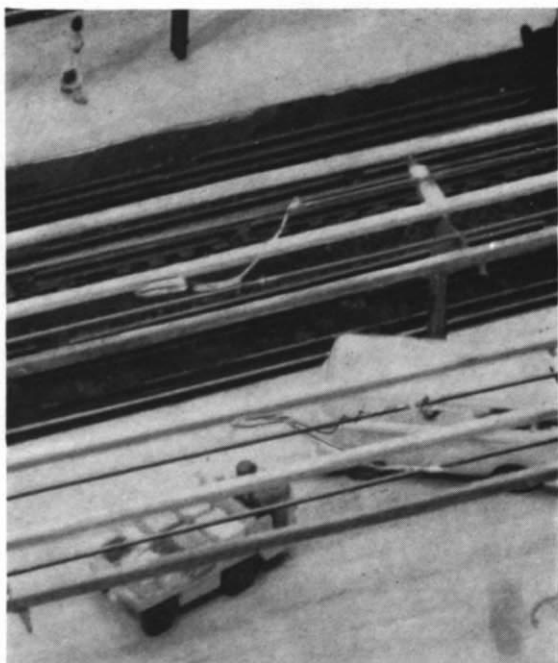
u. 4. Details der Bahnsteig-Überdachung und der Anbringung der Beleuchtungskörper — über dem Gepäckwagen ein auf dem Rücken liegendes Dachteil mit einer der Blechklemmen.
